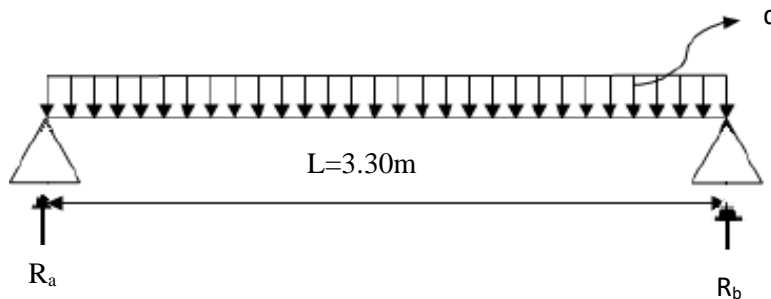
schéma statique de la poutre de chaînage à l’ELU
